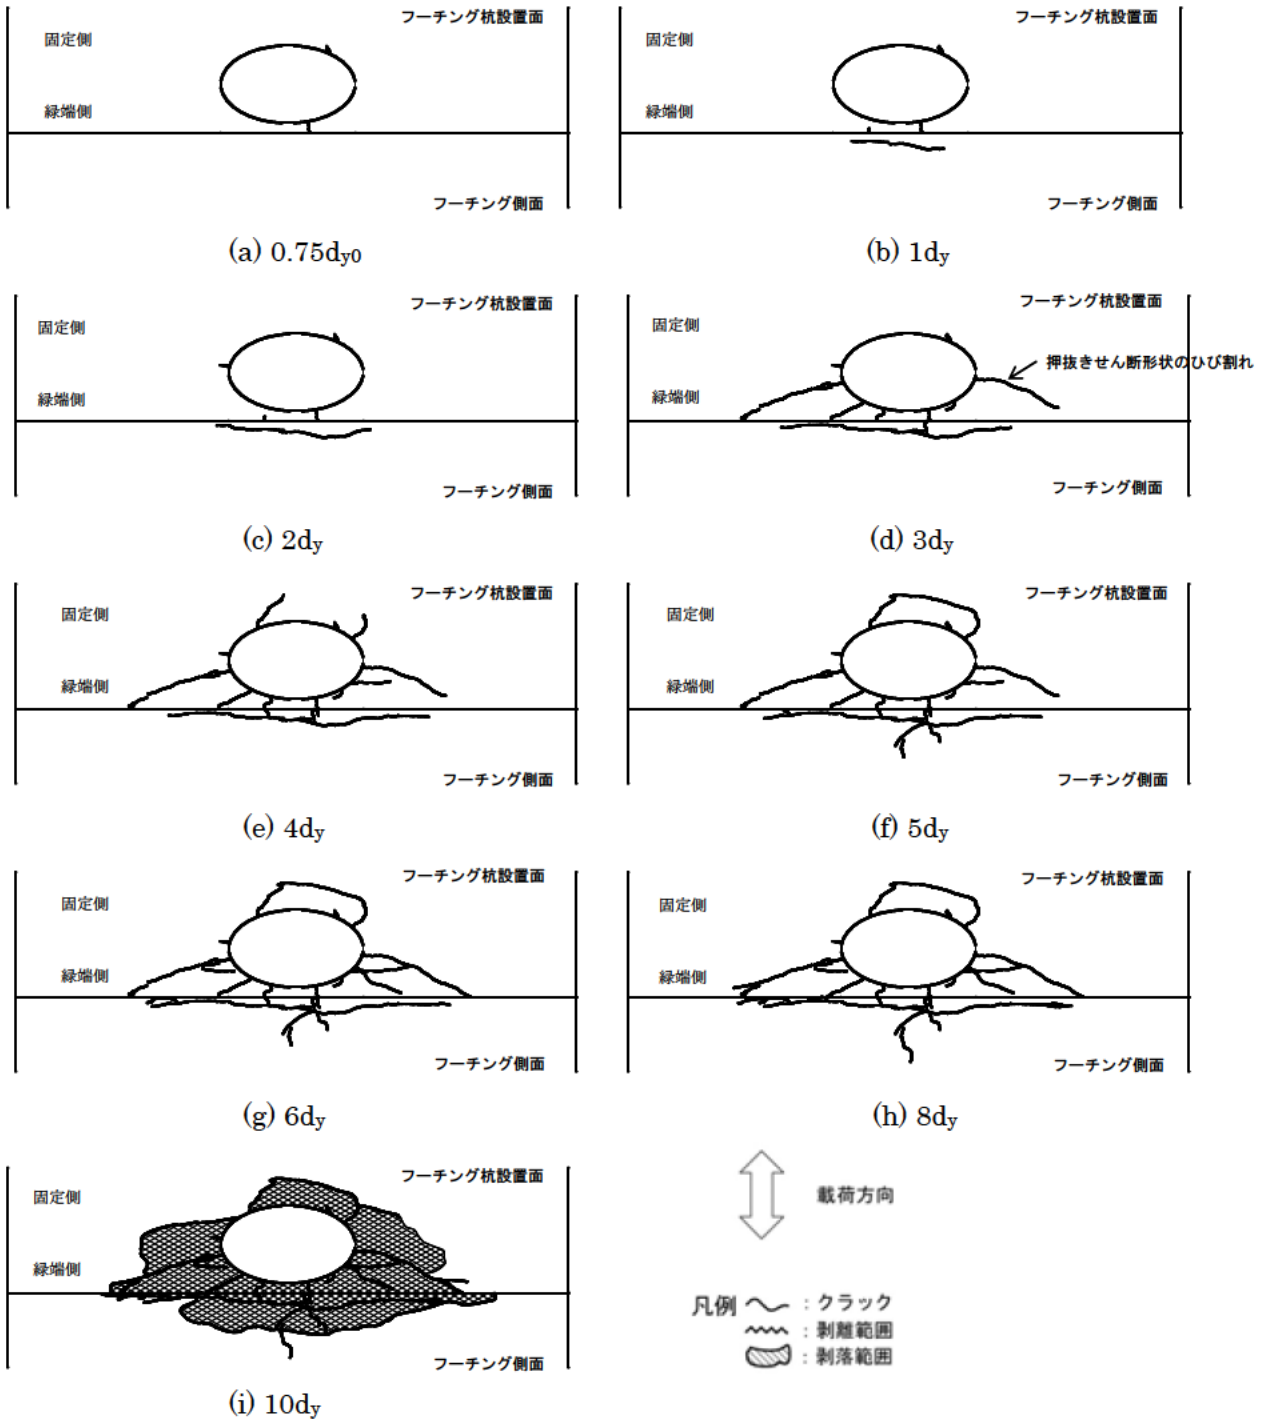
杭設置面フーチングのひび割れ進行状況図 (Case CPP-S-2)
